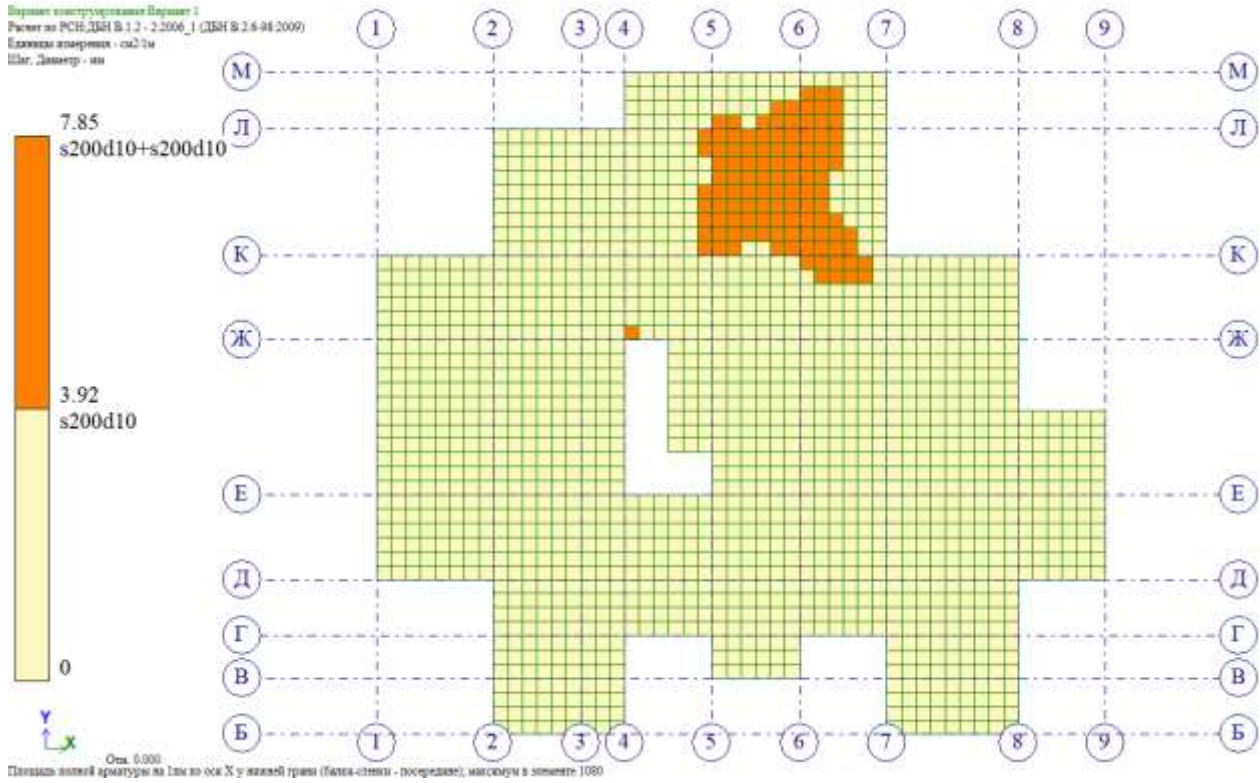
Арматування плити перекриття по нижній грані вздовж осі X
